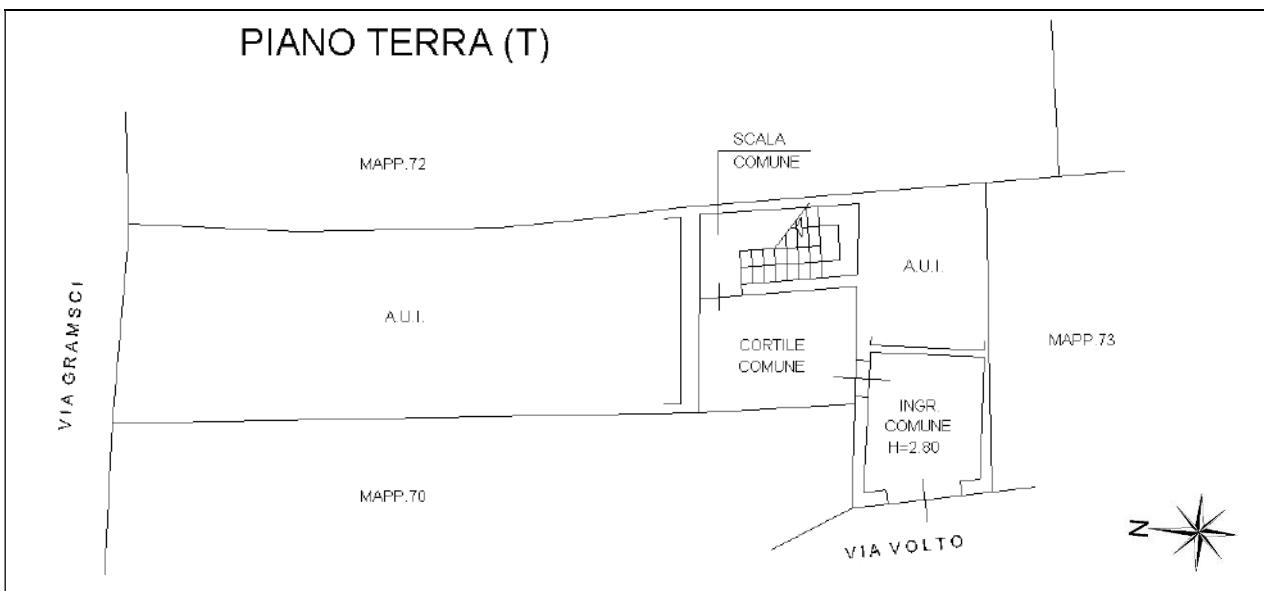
Estratto planimetria catastale Sez. Urb. NCT Fg. 31 particella 71 sub. 3 in banca dati dal 17.11.2014 – piano terra
